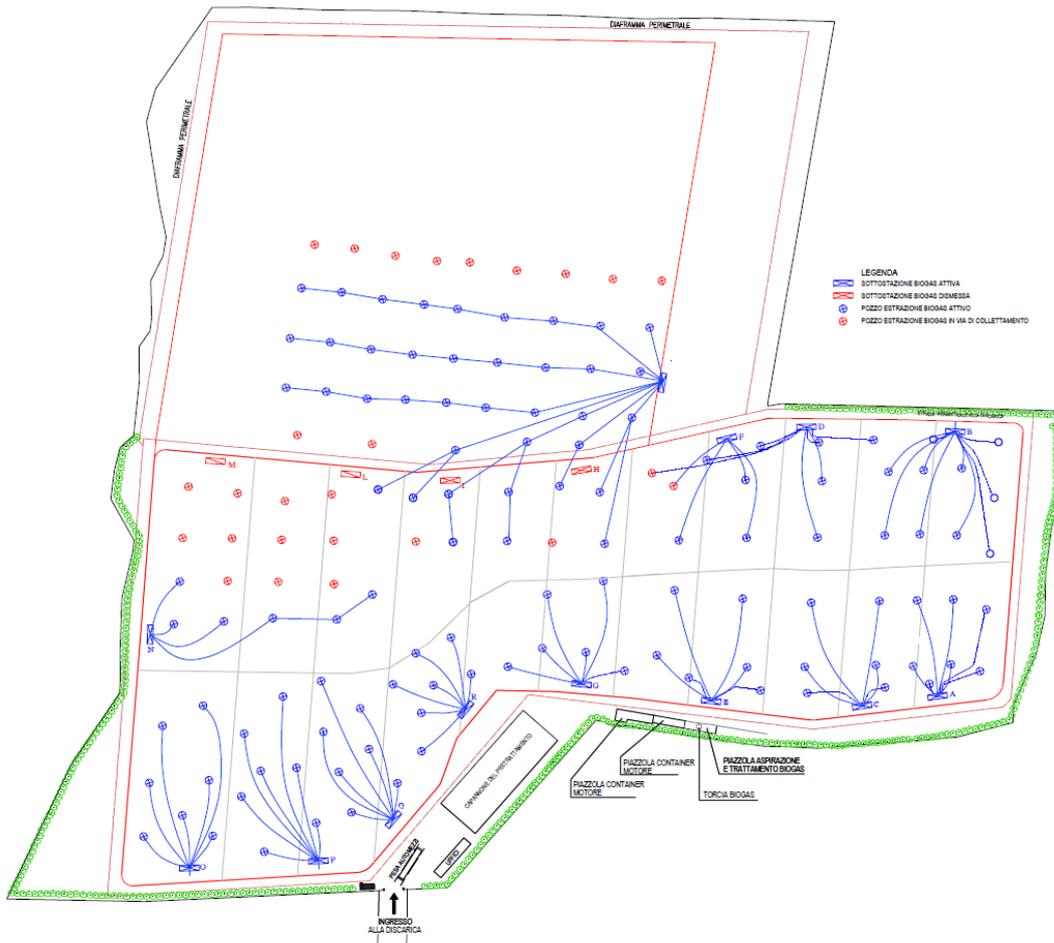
Planimetria stato di fatto impianto di captazione biogas al 30/12/2018
